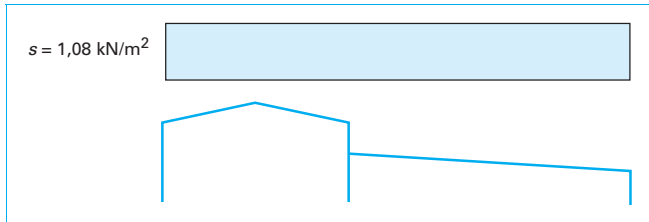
Charge de neige sur les toitures en situation de projet accidentelle
